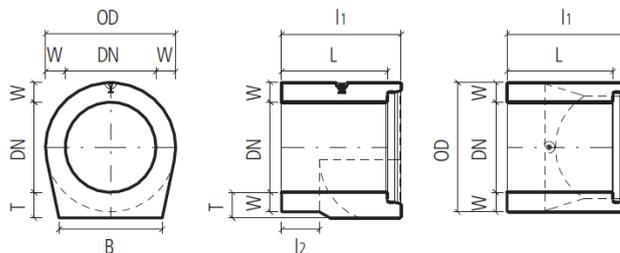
MAROWA® Hochleistungsbetonrohr – Anschlussrohr FLM
